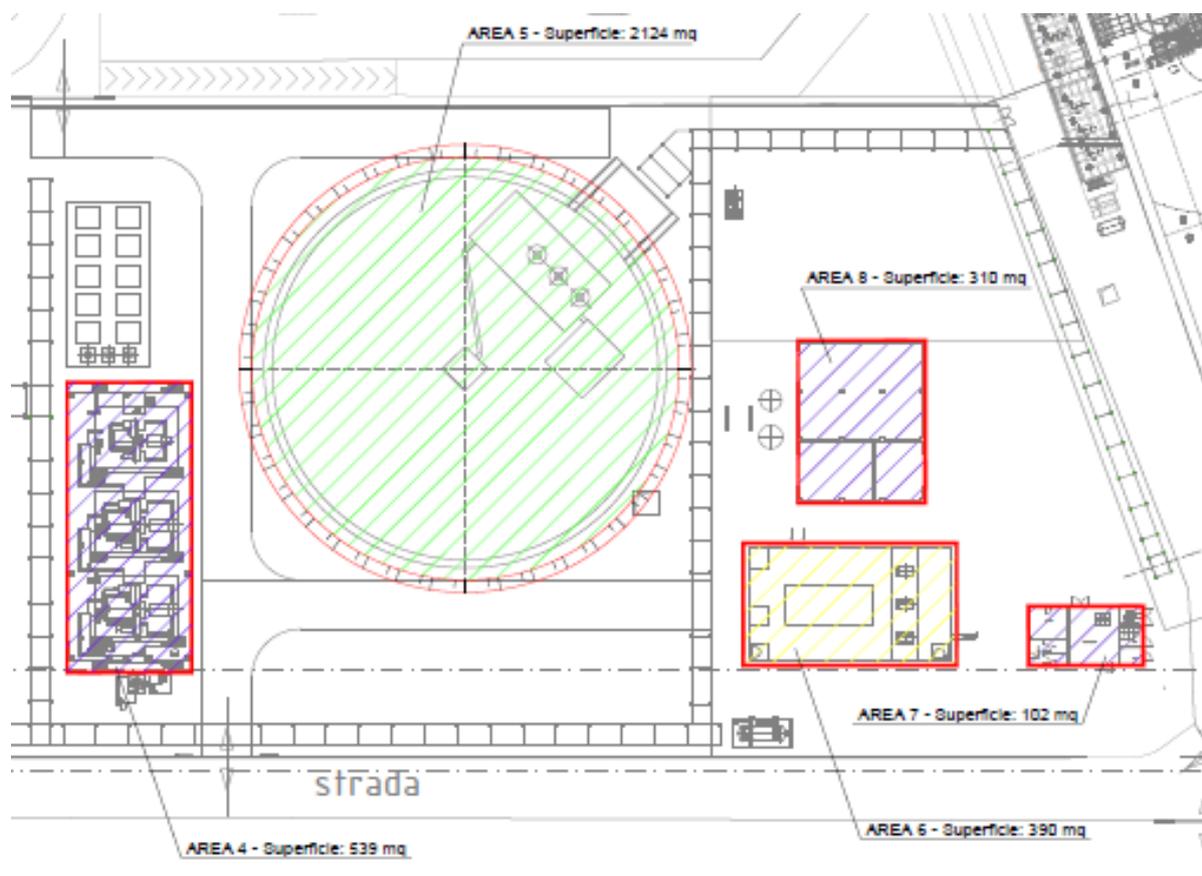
g: Planimetria delle Aree di Scavo a Sezione Obbligatoria per l'Area Nord dell'Impianto
